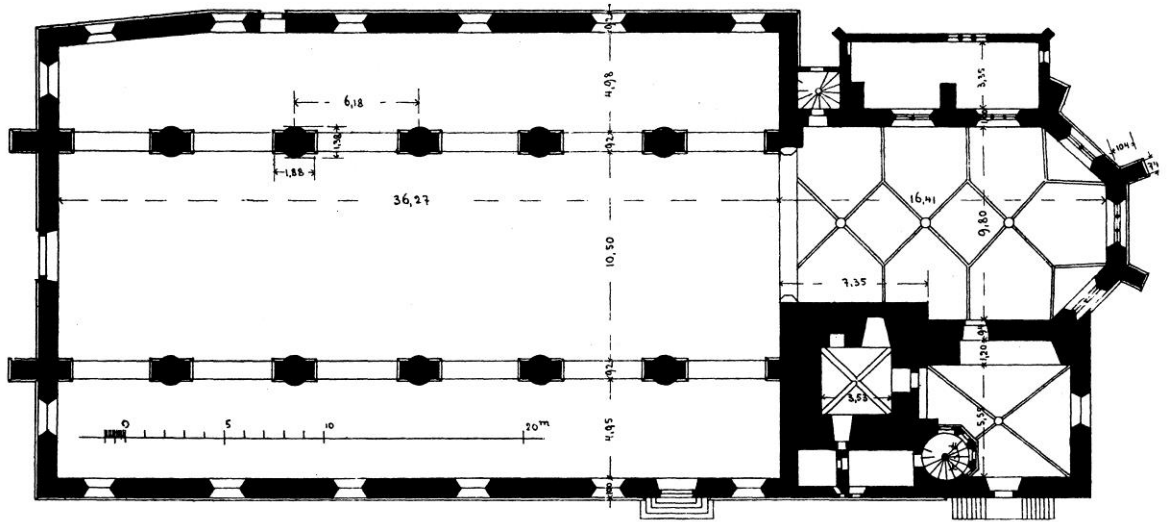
Rottenburg, Dom St. Martin, Grundriss (Aufmaß um 1895)
